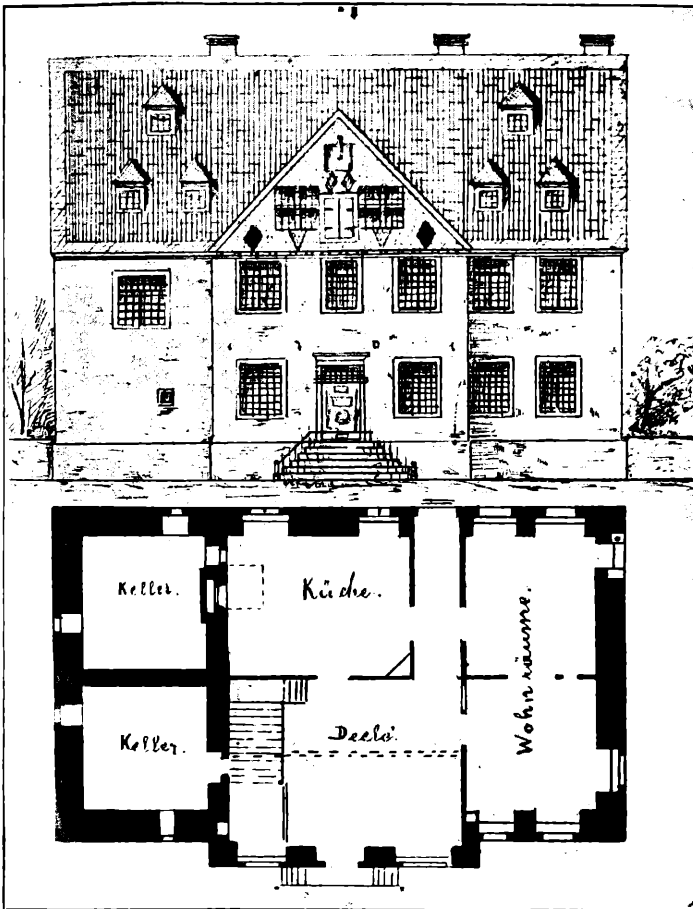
Grundriss und Ansicht eines Barmer Hauses von 1701.
